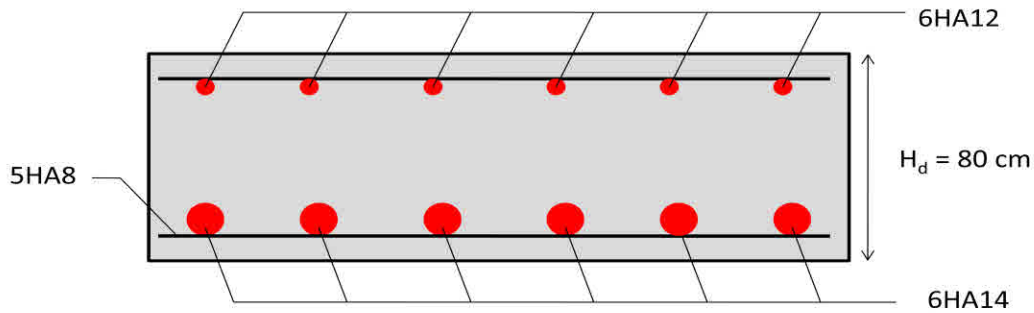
Schéma de ferrailage du débordement (1 ml)
